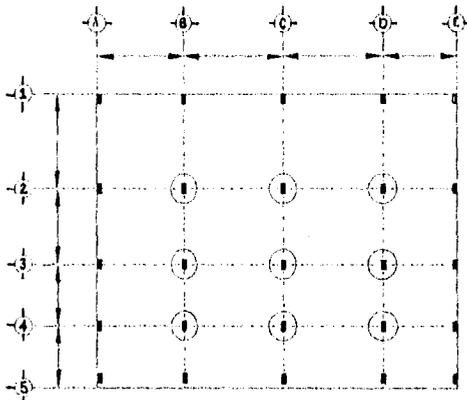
III PROTECCIÓN EXTERIOR EN PLANTA BAJA.
